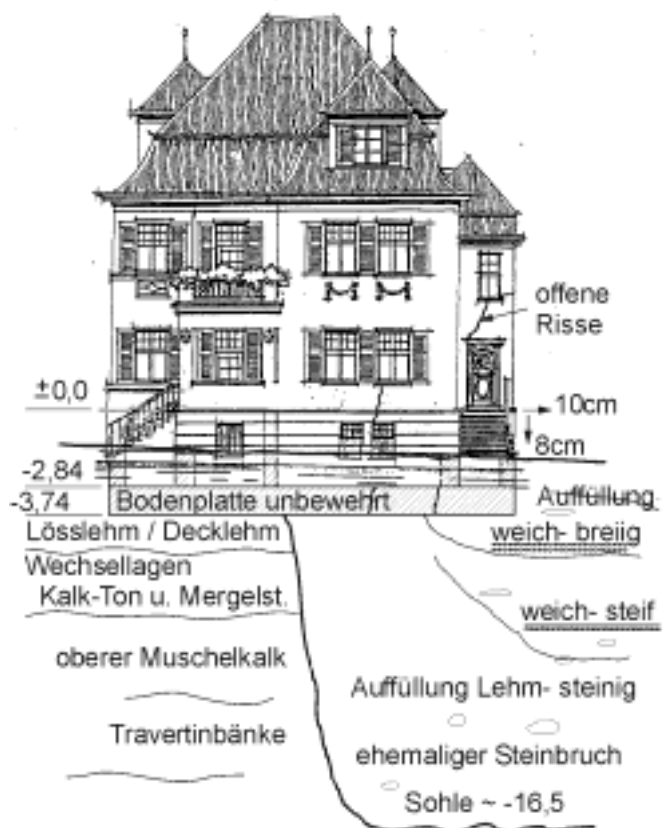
Beispiel einer Nachgründung, Bauwerk und Baugrundsituation
